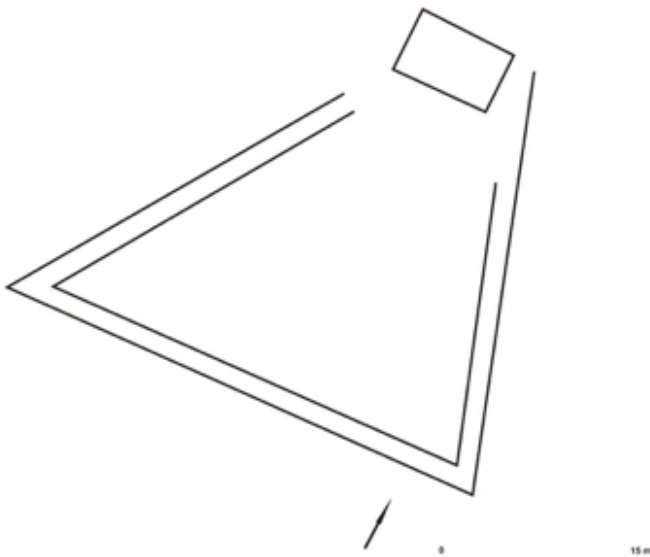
Croquis de planta de Castillo del Zau (Valverde del Camino).
